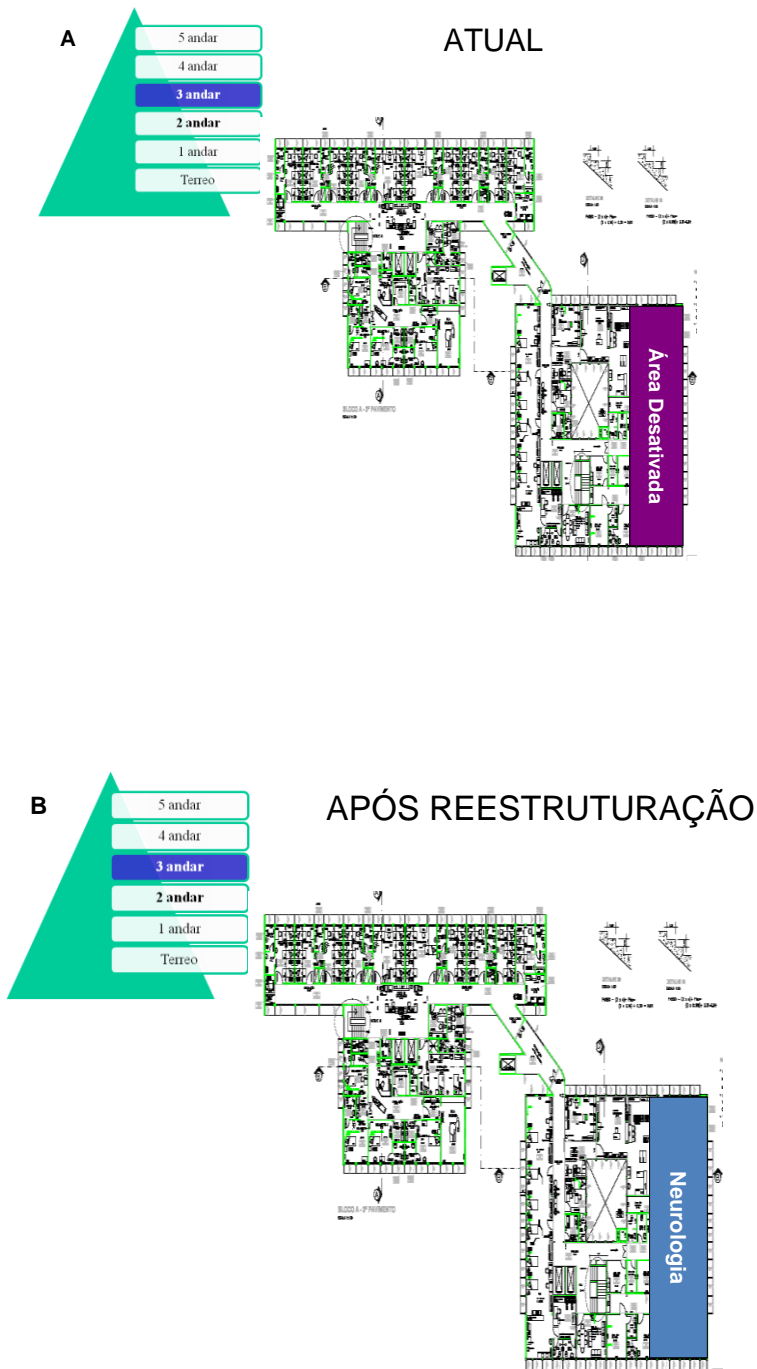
Planta do Terceiro Pavimento da U.E. – HCFMRP – USP na situação atual (A) e após a reestruturação (B) proposta.
